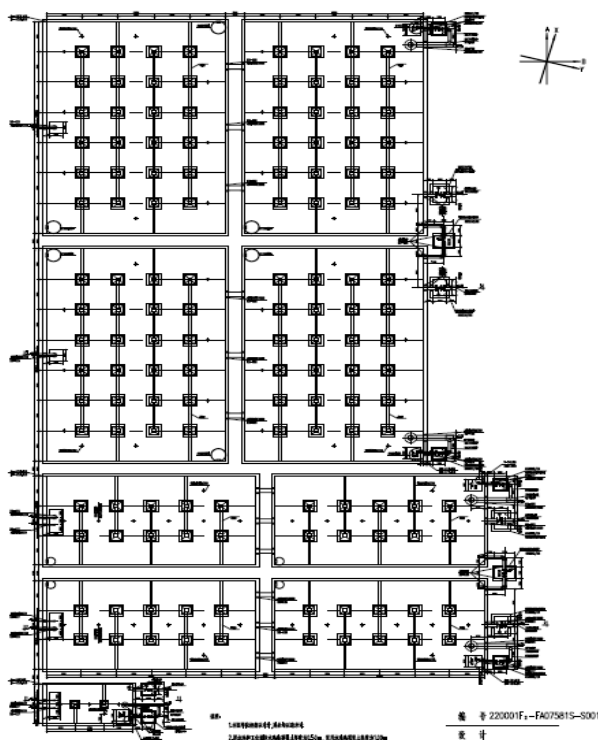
Planta dos tanques de água da CCC do Soyo.
